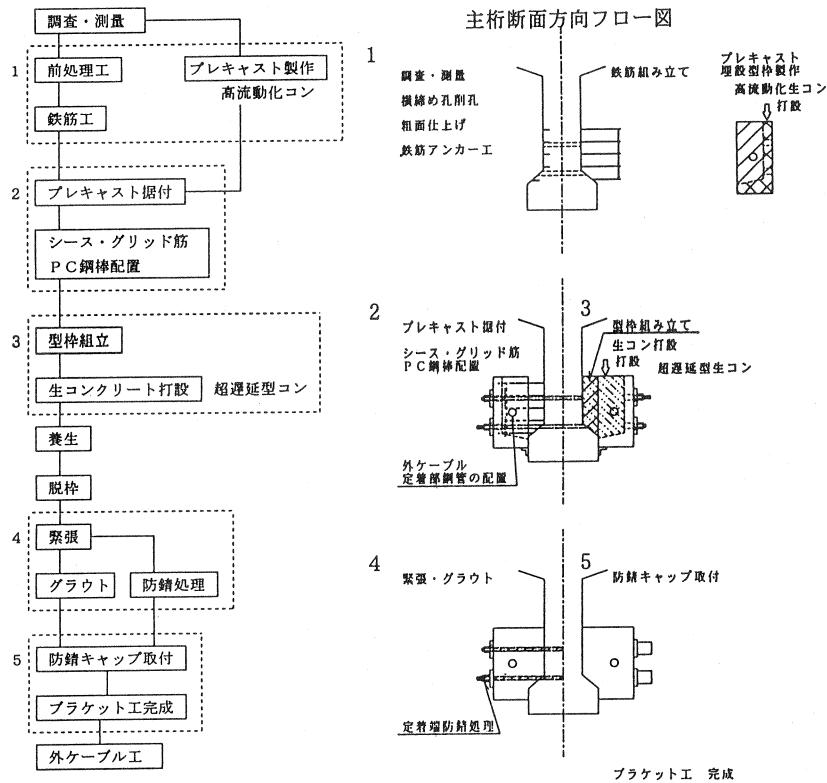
プレキャスト埋設型枠工法の施工手順と施工要領
